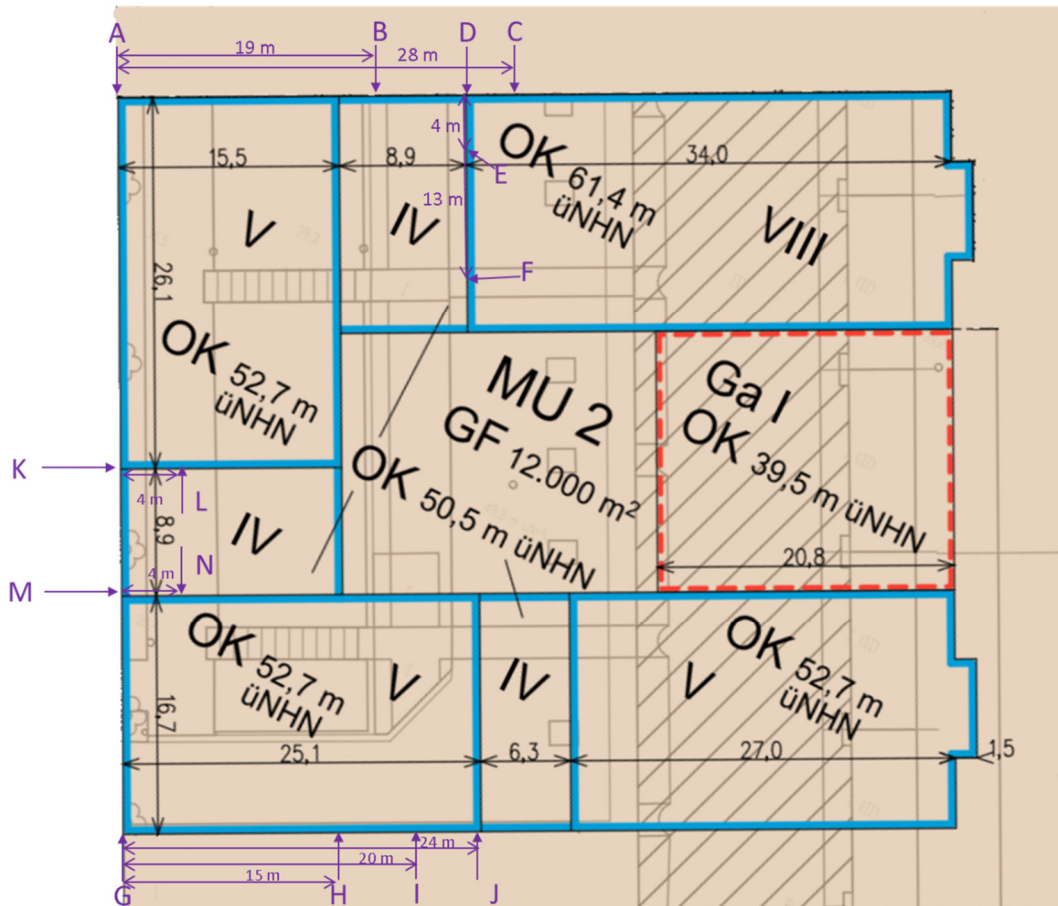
Bebauungsplan I-91-1, Neubau; Punkte (violett) für textliche Festsetzungen zum Schallschutz
